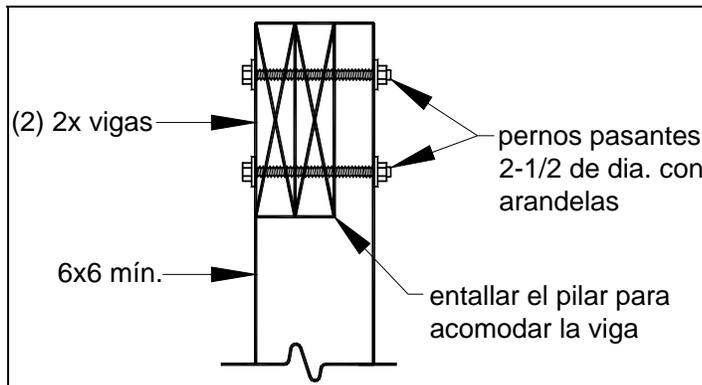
REQUISITOS DE UNIÓN DEL PILAR CON LA VIGA
